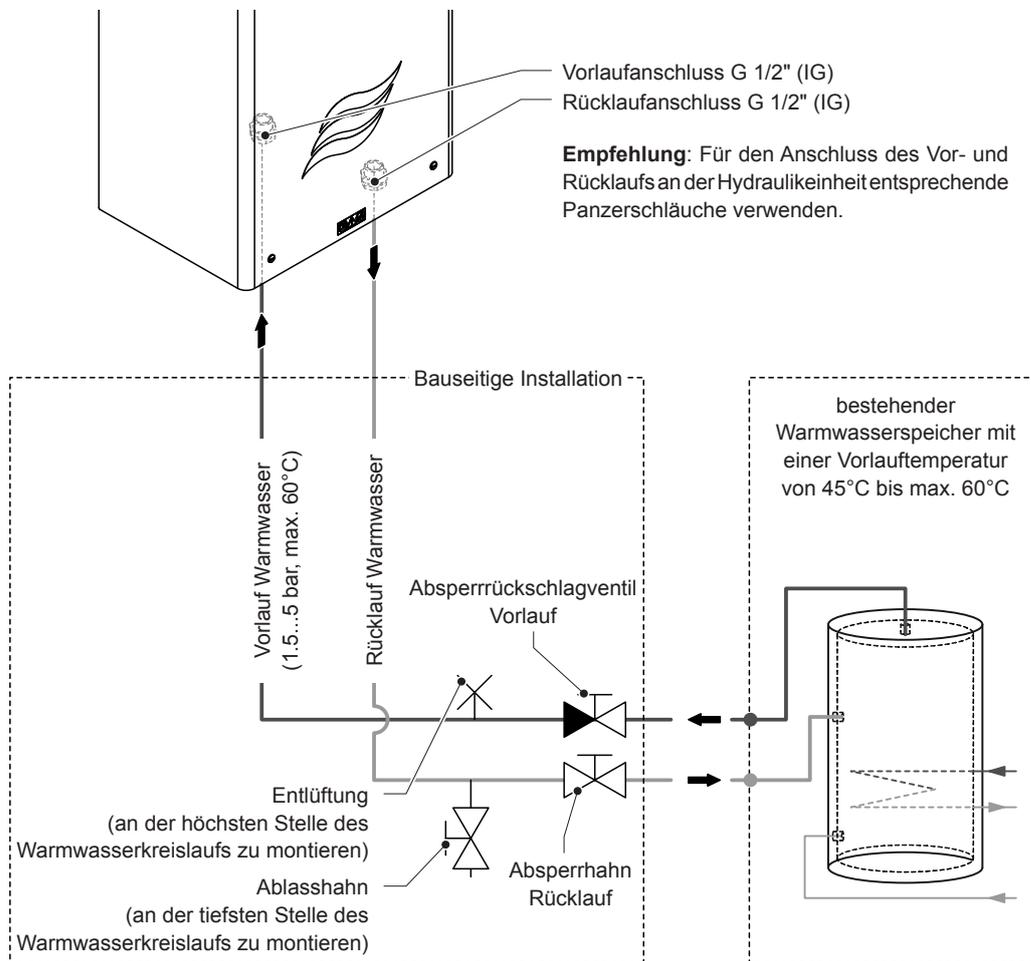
Installationsübersicht Warmwasseranschluss für Variante WW
